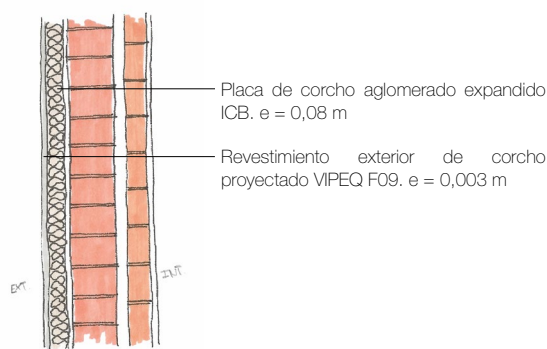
Sistema de aislamiento SATE aplicado la pared Norte y la pared Sur (autoría propia).
